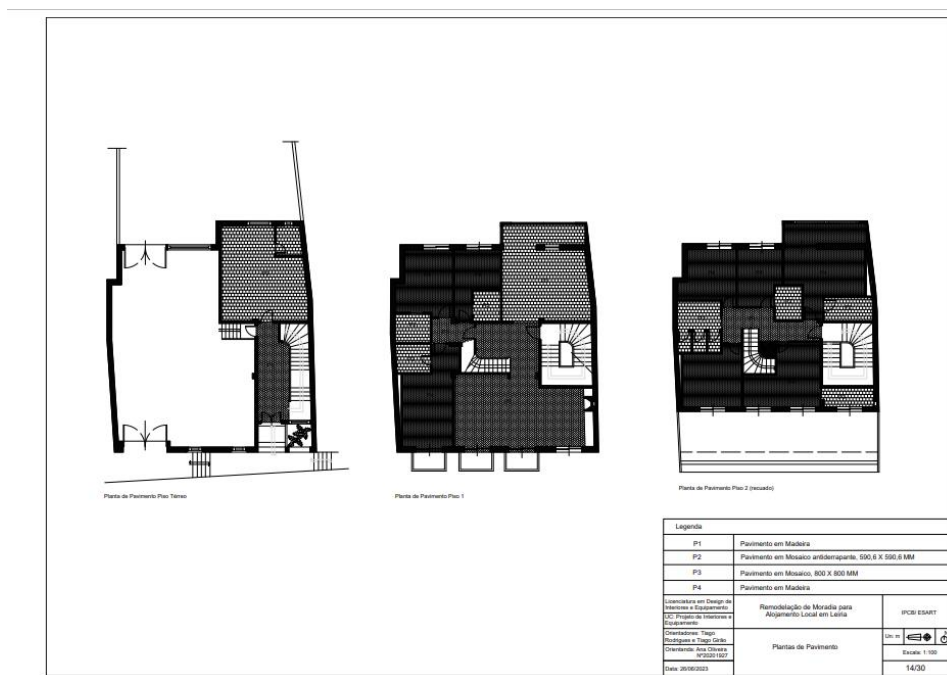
Plantas de Pavimento, Pisos Térreo, 1 e 2, fonte a autora
